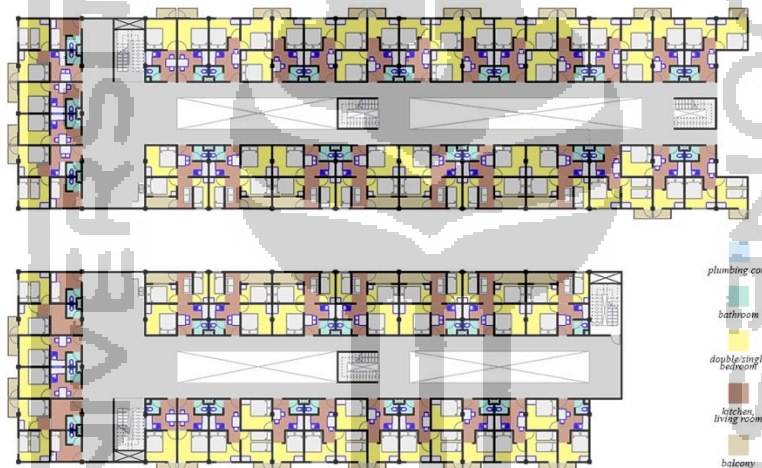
44 Skematik Layout Bangunan 1st Floor
